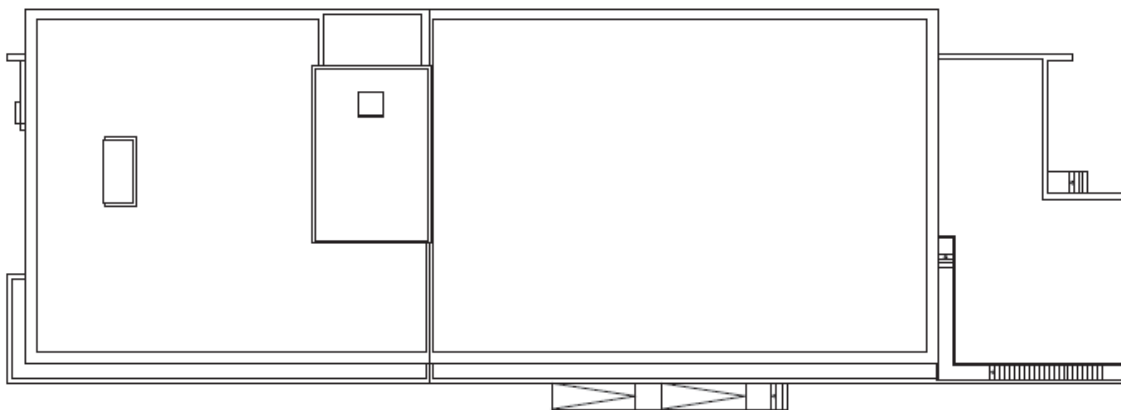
CeTeMares_Planta de Cobertura, sem escala, 10.03.2022, Instituto Politécnico de Leiria.
